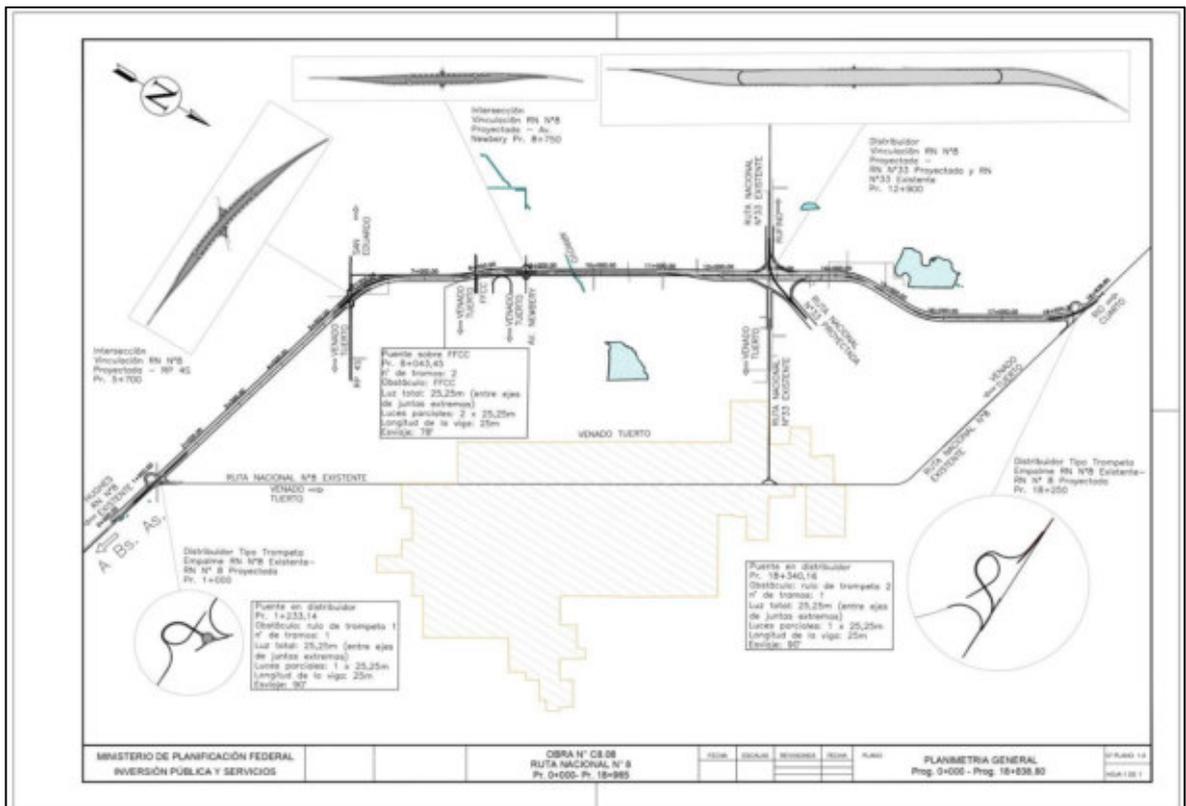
Proyecto vigente nueva traza ruta nacional N°8.
